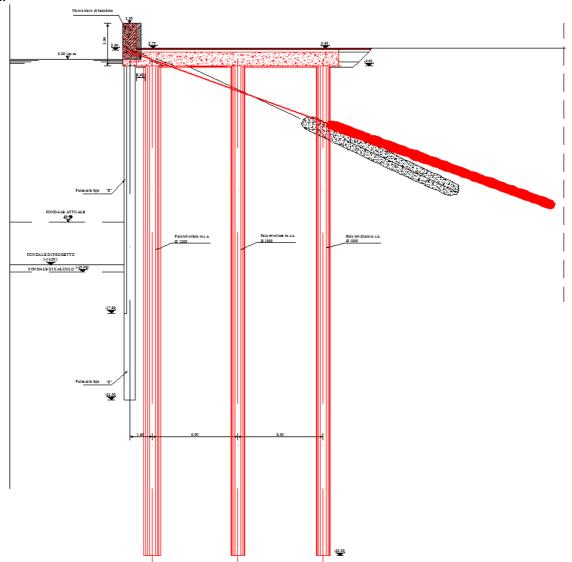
Sezione adeguata della banchina BUNGE SUD
